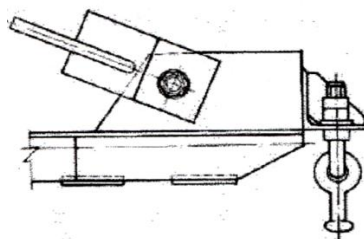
Крепление гирлянды на траверсе железобетонных опор
